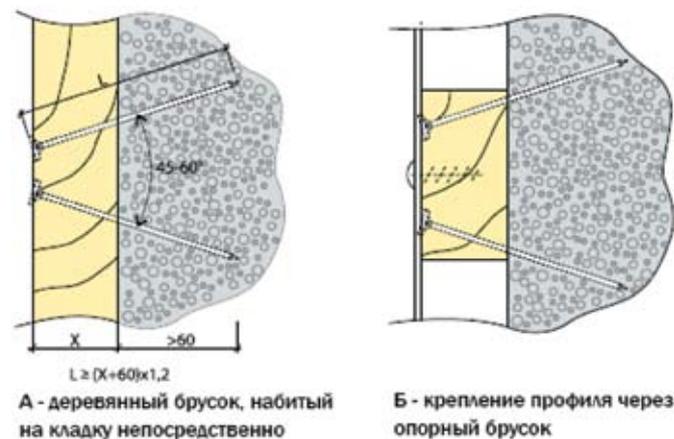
Гвоздевое крепление обрешетки навесного фасада к газобетонной кладке в малоэтажном строительстве
